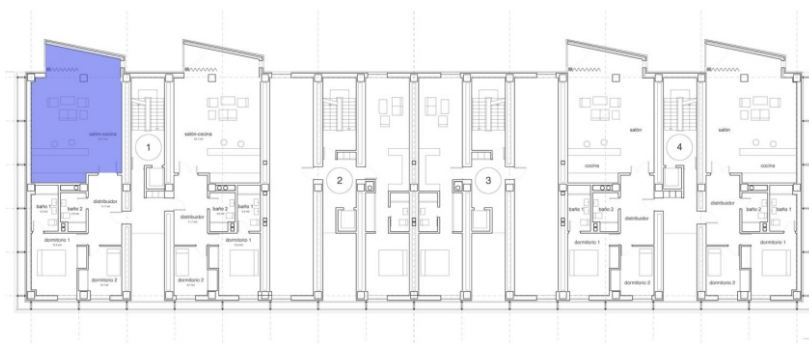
Salón de vivienda tipo 9 en planta 4º
